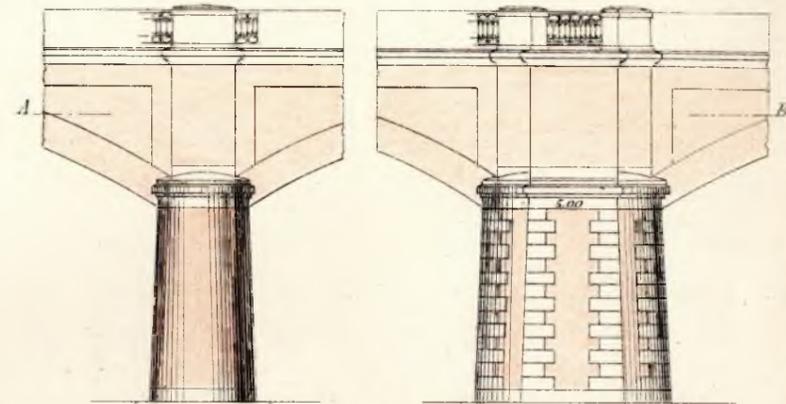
Sezione longitudinale verso la spalla.
